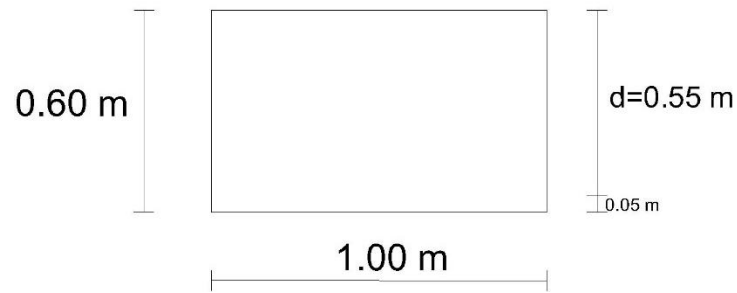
79: Geometría de la viga de asiento (Fuente: Elaboración propia)
